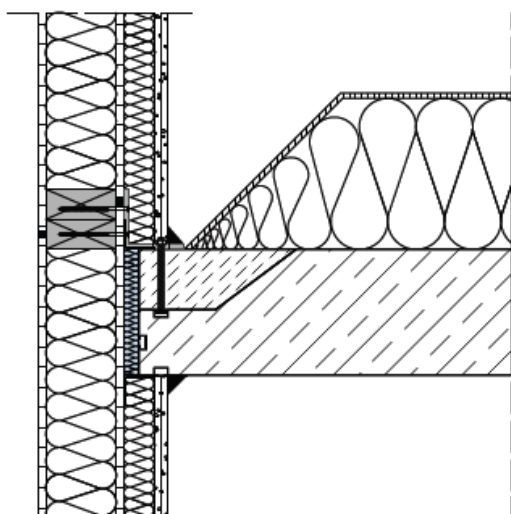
Prüfvariante: Vorgestellte Fassade mit Vorsatzschale im Vertikalschnitt (Eigene Darstellung)
